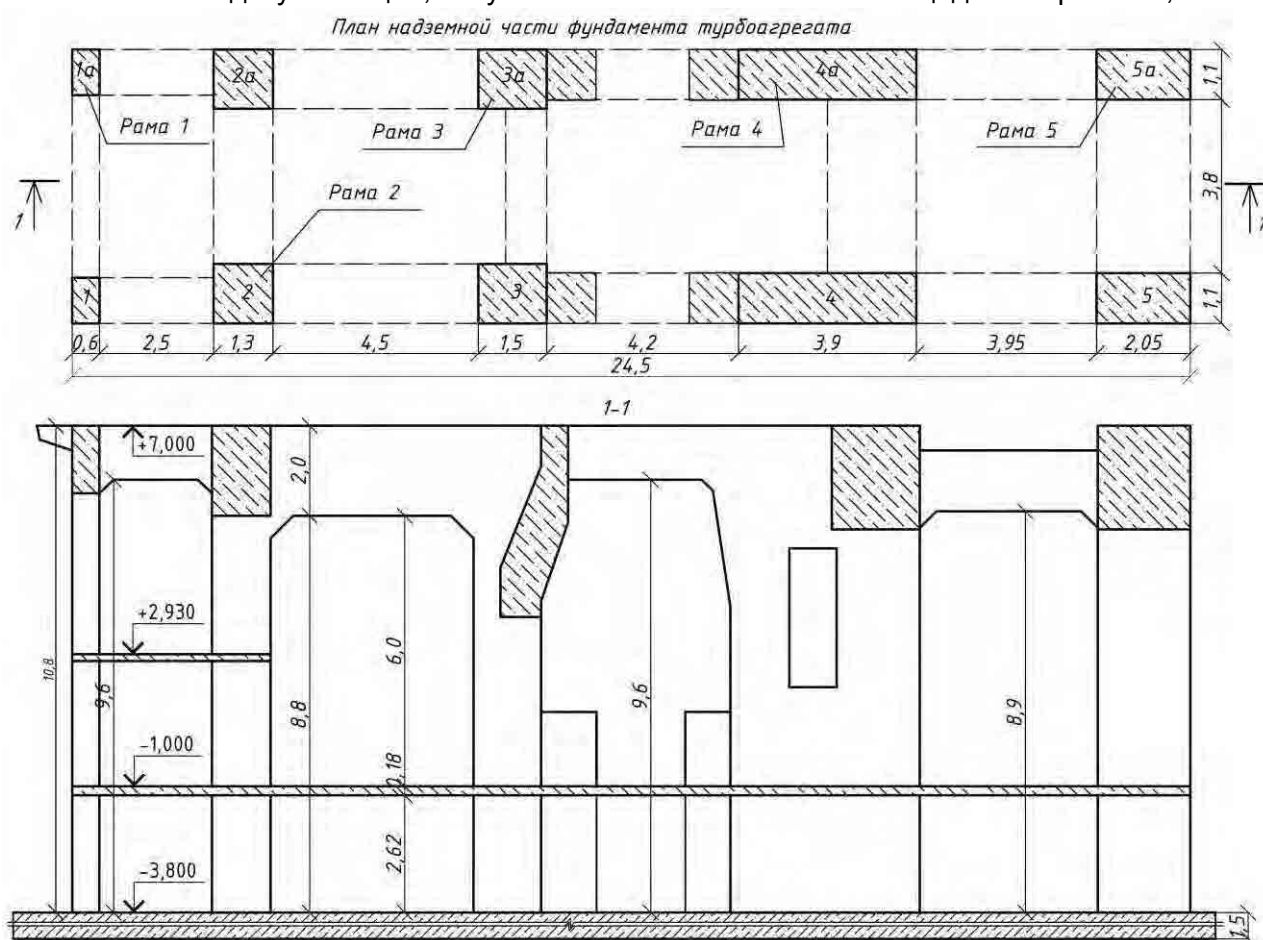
План и разрез надземной части фундамента турбоагрегата
